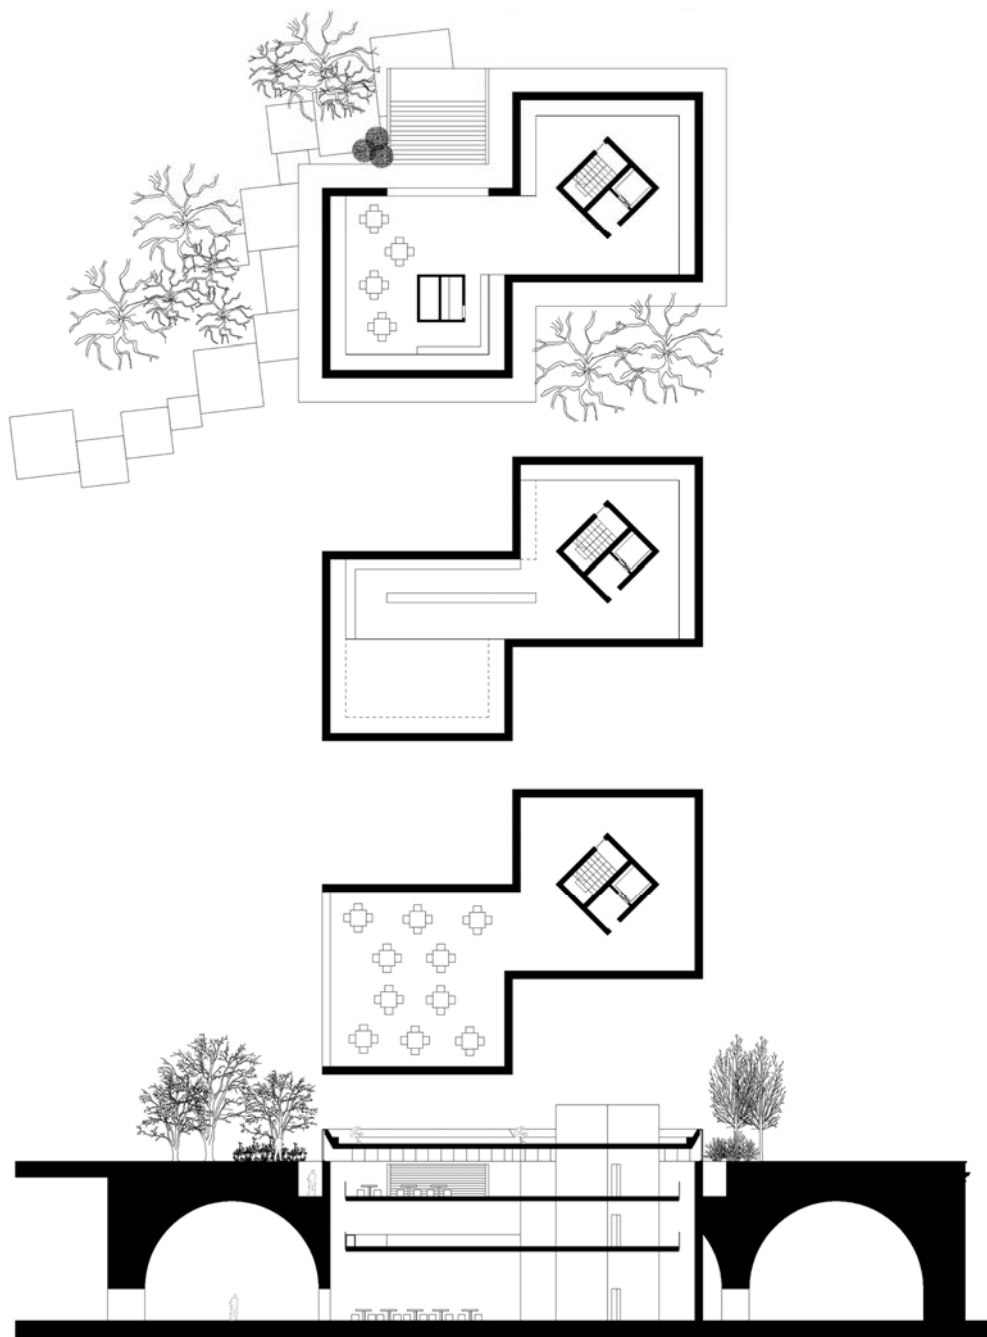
Plantas e cortes do Restaurante (ilustração nossa, 2012)
